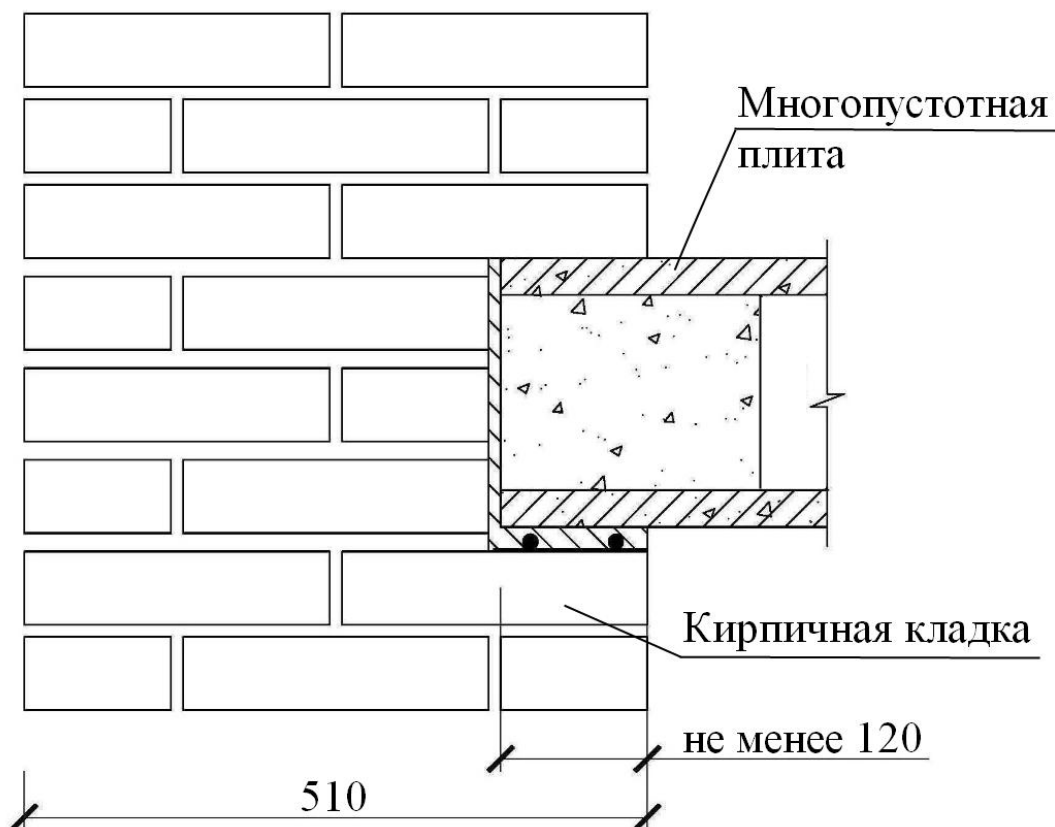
Схема опирания многопустотных плит на кирпичную кладку
